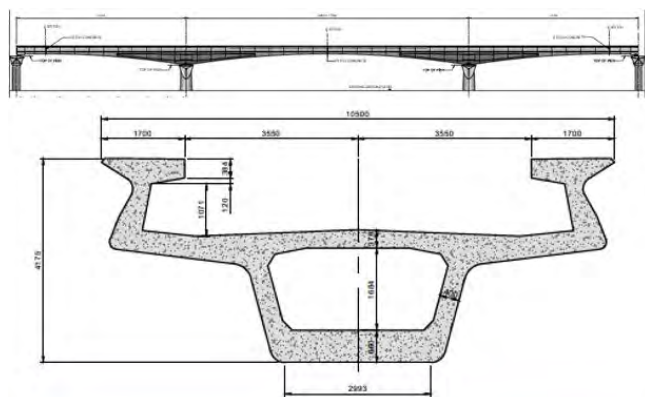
Alzado y sección sobre apoyos del 3span. Colocación de dovelas prefabricadas mediante ejecución por voladizos.
